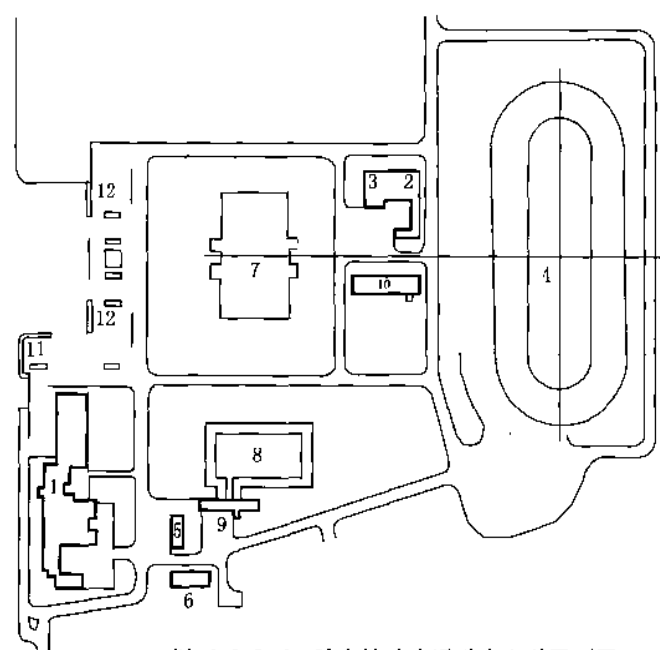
哈尔滨冰上运动中心总平面图
